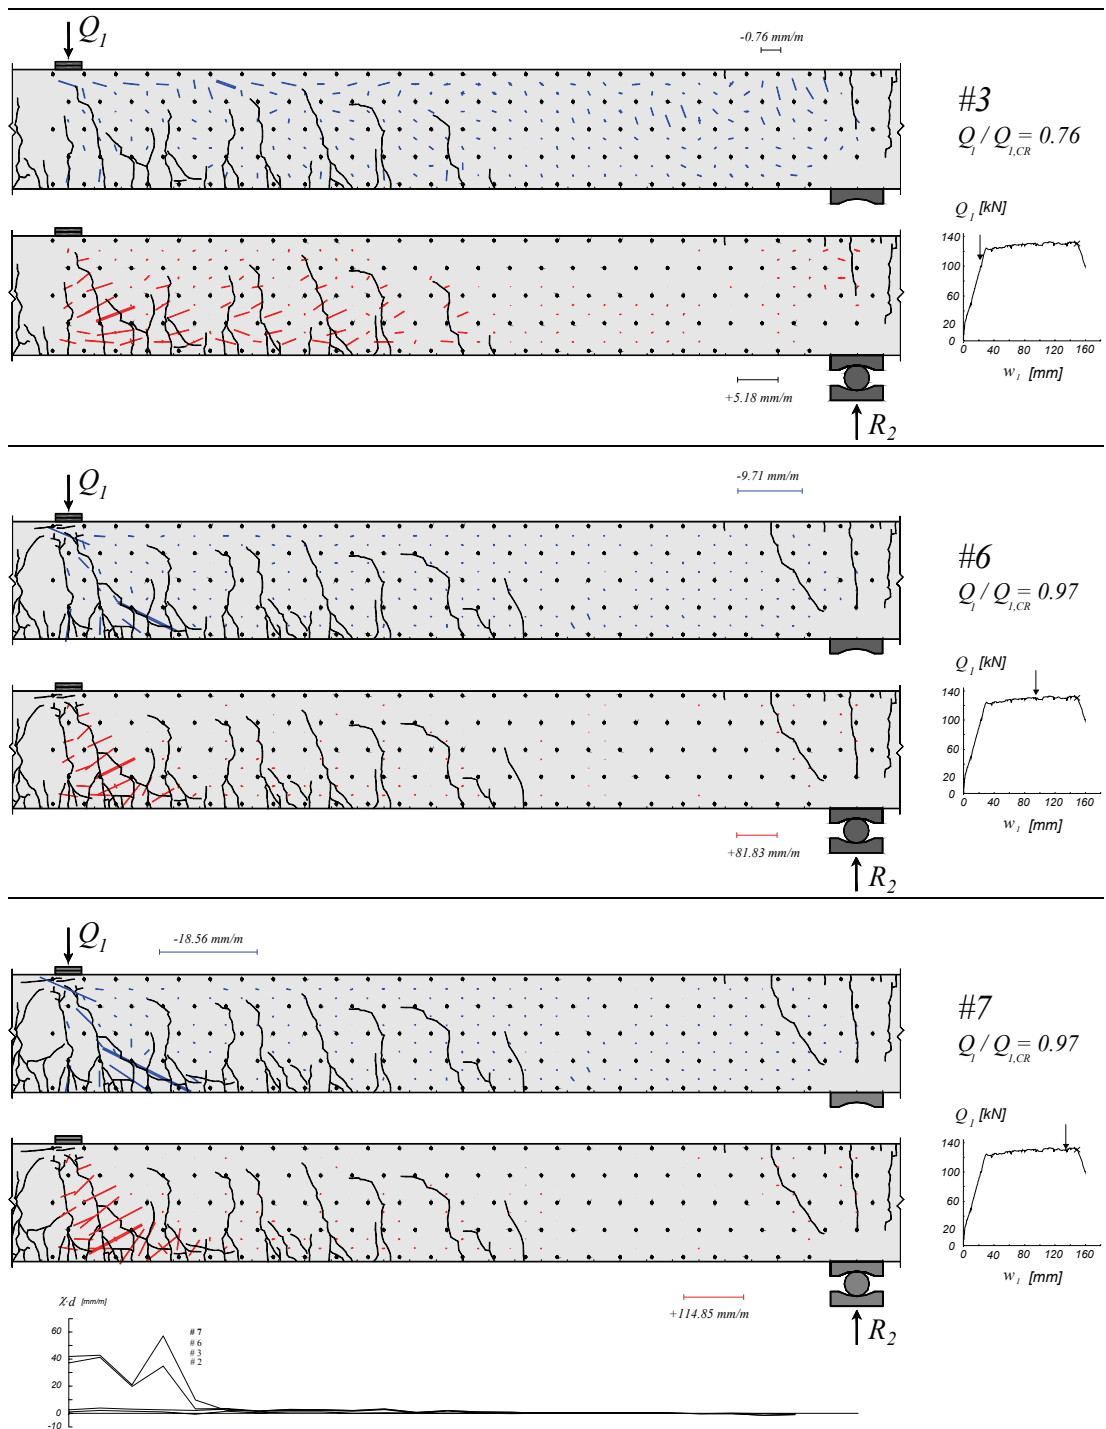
Poutre SR12: déformations principales, fissuration et courbures
